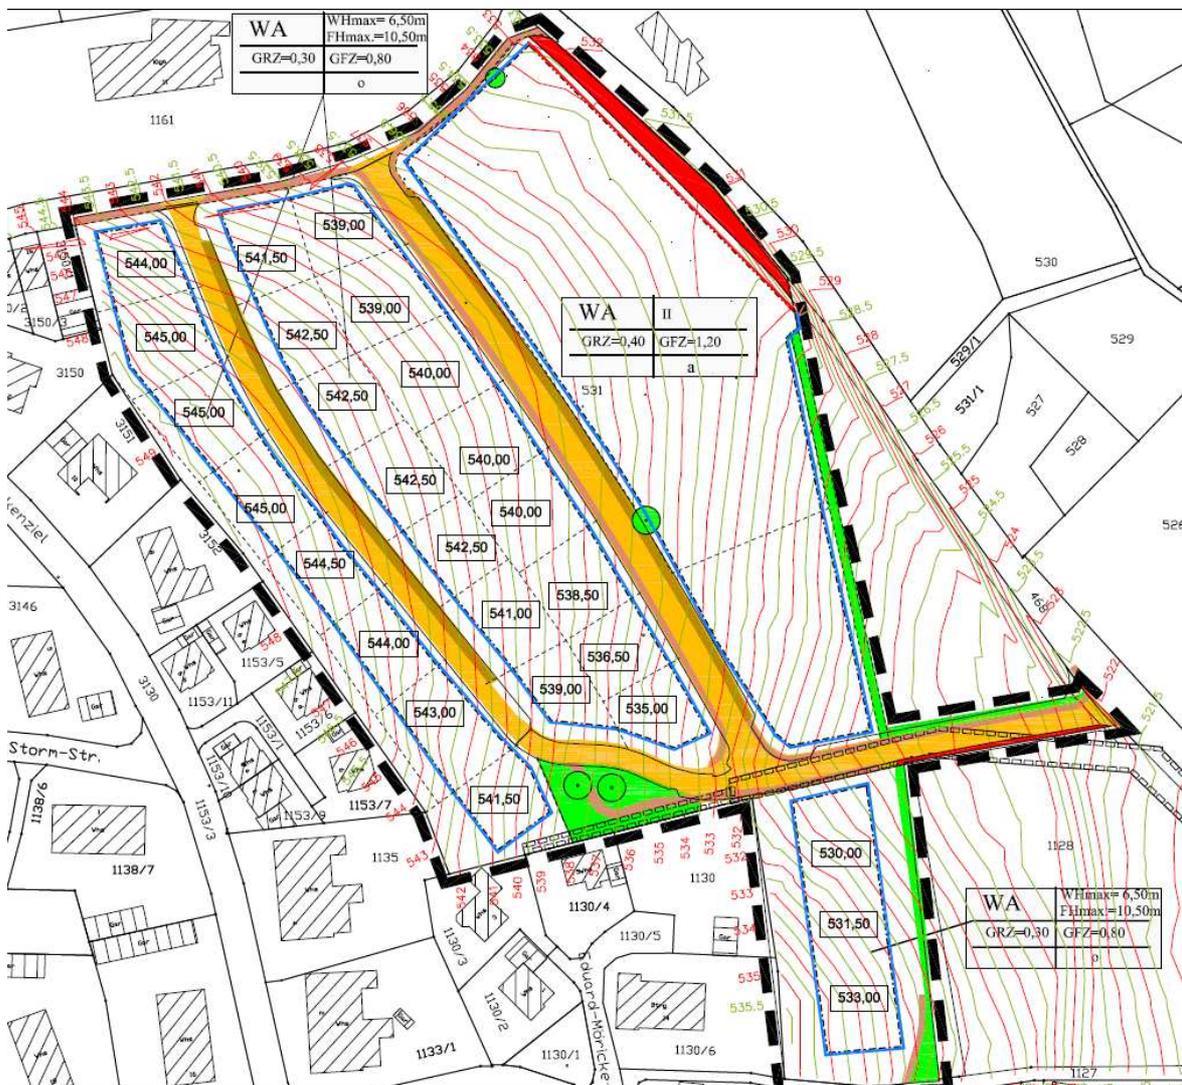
Rechtsplan zum Bebauungsplan „Glockenziel III“ vom 03.03.2016
